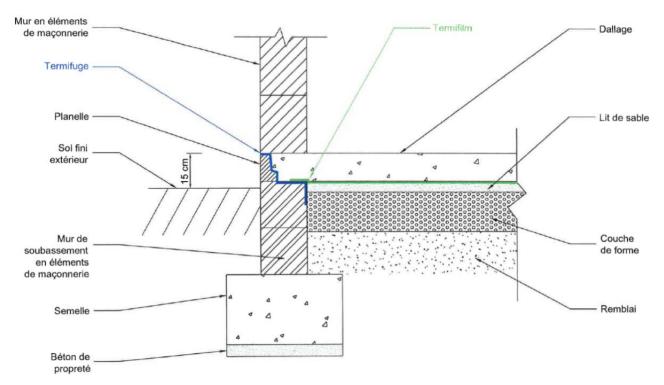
Dallage solidarisé avec planelle, soubassement maçonnerie – DROM/COM
